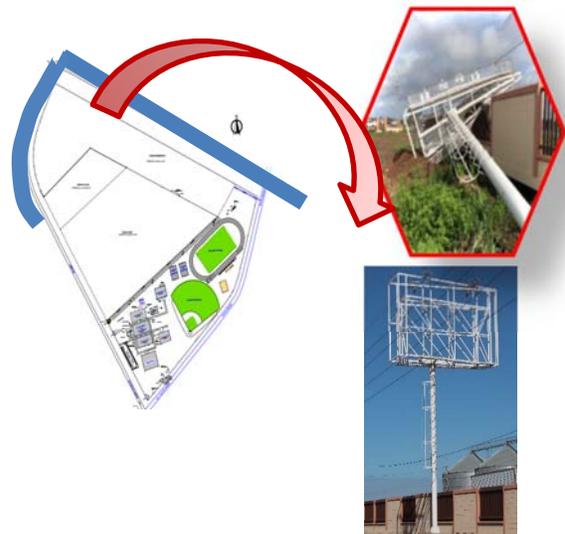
Imagen de barda Muro-reja con afectación estructural (derrumbe de barda)
